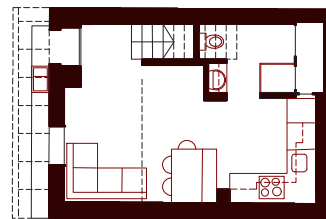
Planta baixa tipo A Ilha da Bela Vista - LAHBSocial
